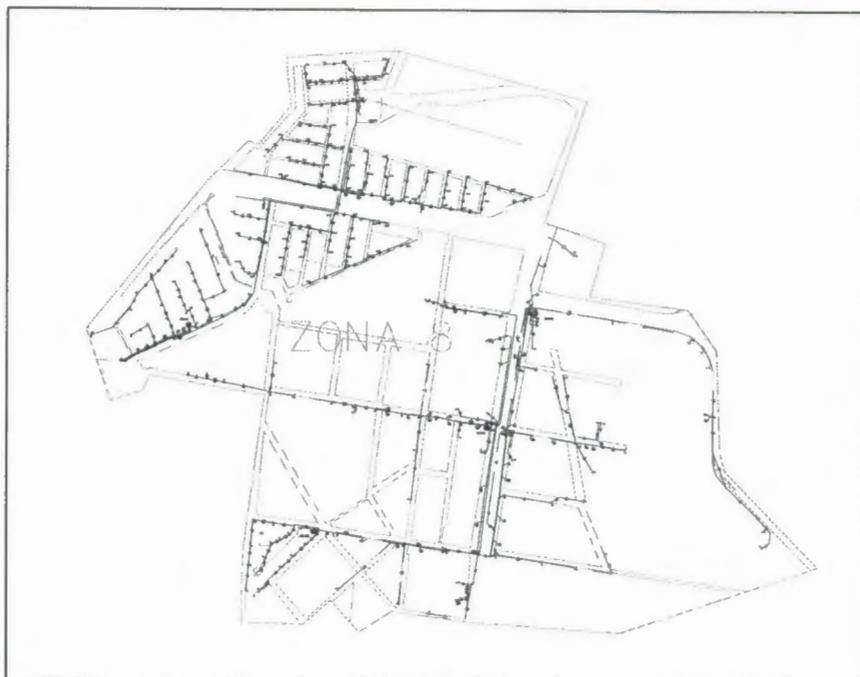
Planimetría zona 8 del sector de la vía a Daule
